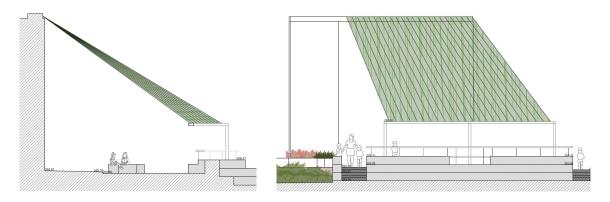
Perfil de variante de mBiGFAC. Fuente: Proyecto básico y de ejecución EB1 de Horta das Figueiras
